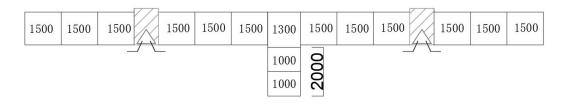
T型双柱导架爬升式工作平台示意图(单位: mm)
